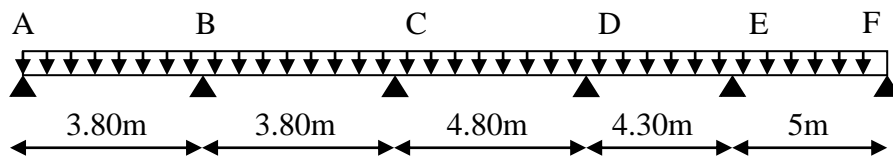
schéma statique de poutrelle étage commercial type 01.
